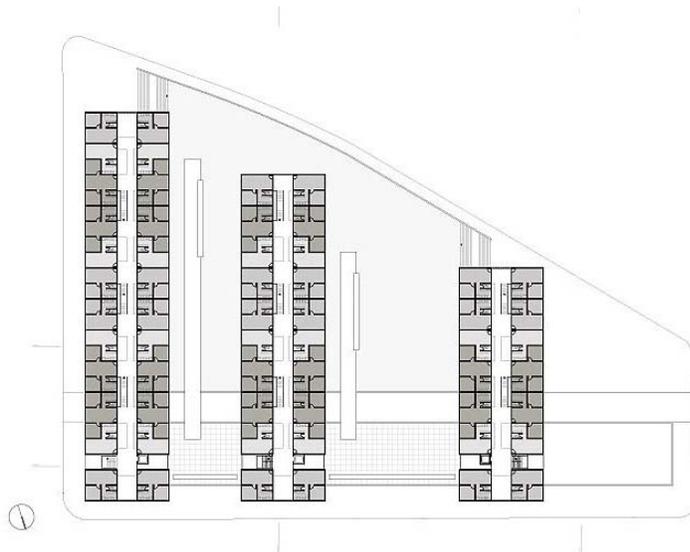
Planta: pavimento-tipo (/esc).
